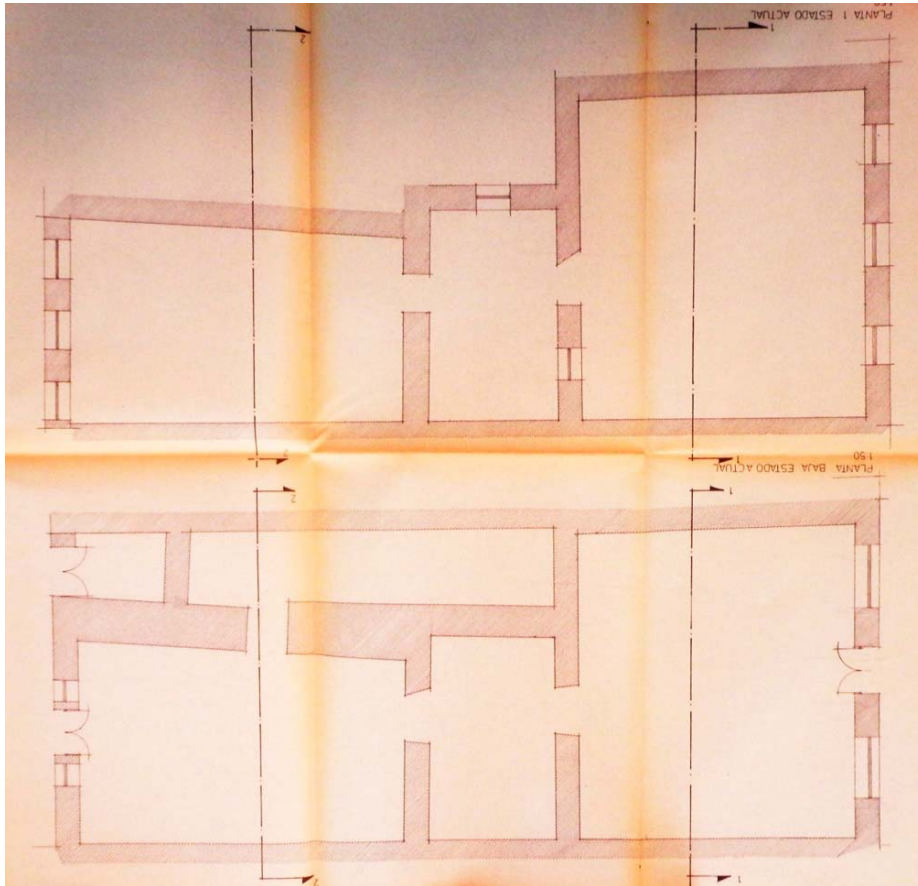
Plantas baja y primera de estado previo de la casa consistorial de Pontedeume, del proyecto de 1971. APJAFT. Giradas con orientación a la izquierda hacia la Plaza Real y a la derecha hacia la Rúa dos Ferreiros.
